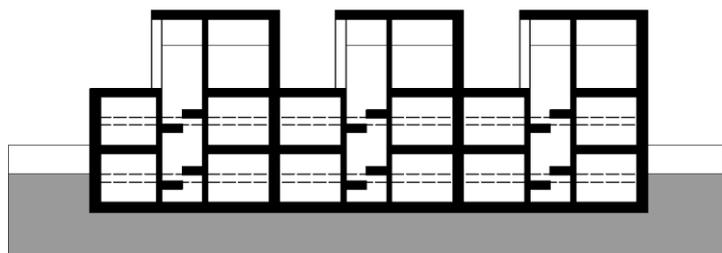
Reihenhausbauung Typ 3, Planung: Büro f64
